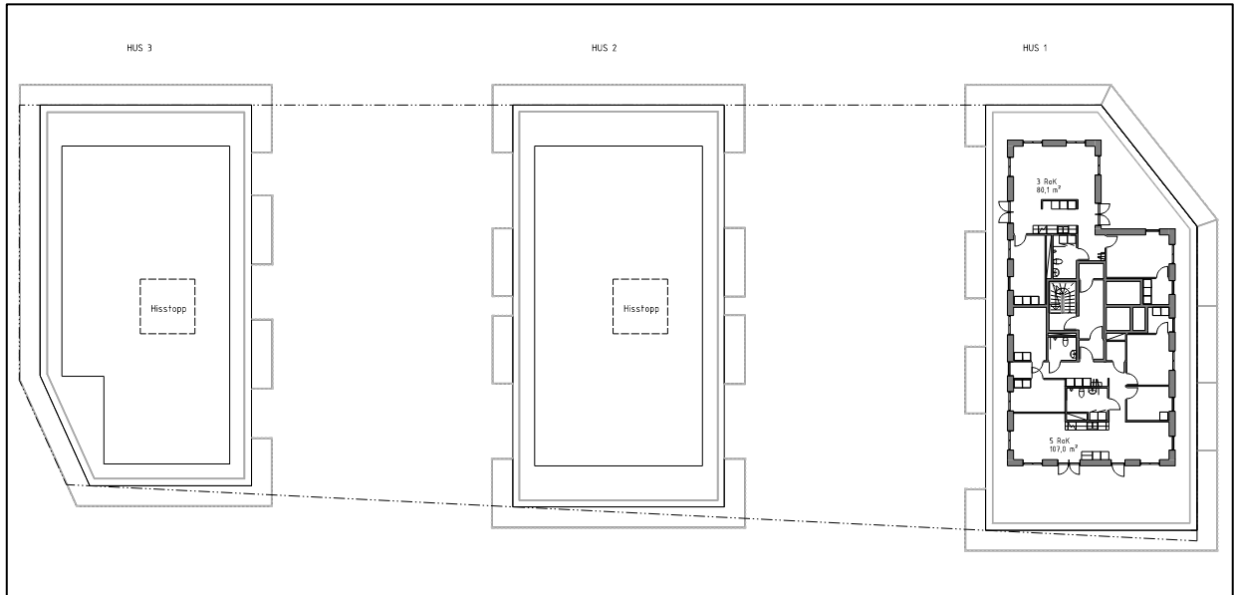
Planlösningar plan 11 i östra kvarteret. Samtliga lägenheter klarar kraven i Trafikbullerförordningen.
